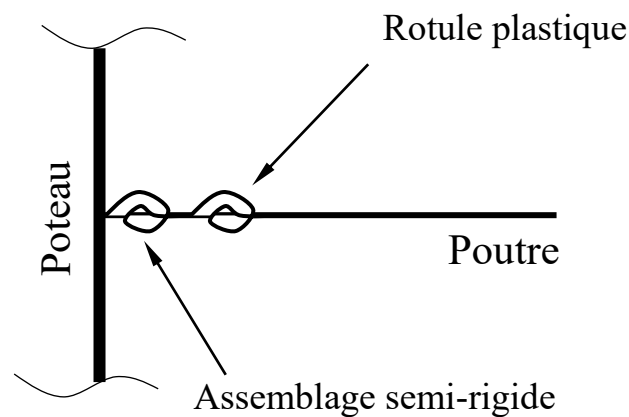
Modélisation des nœuds poteau-poutre.
